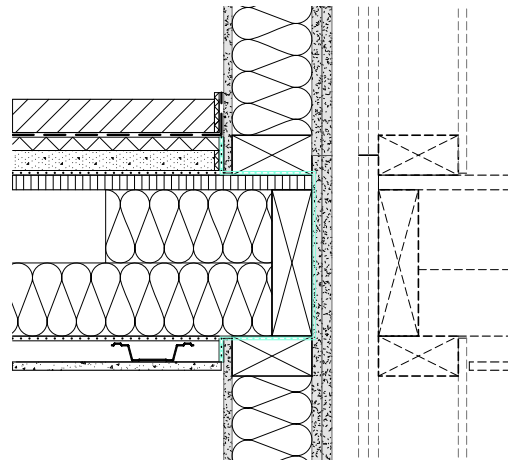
Anschluss Geschosdecke an Gebäudetrennwand.
